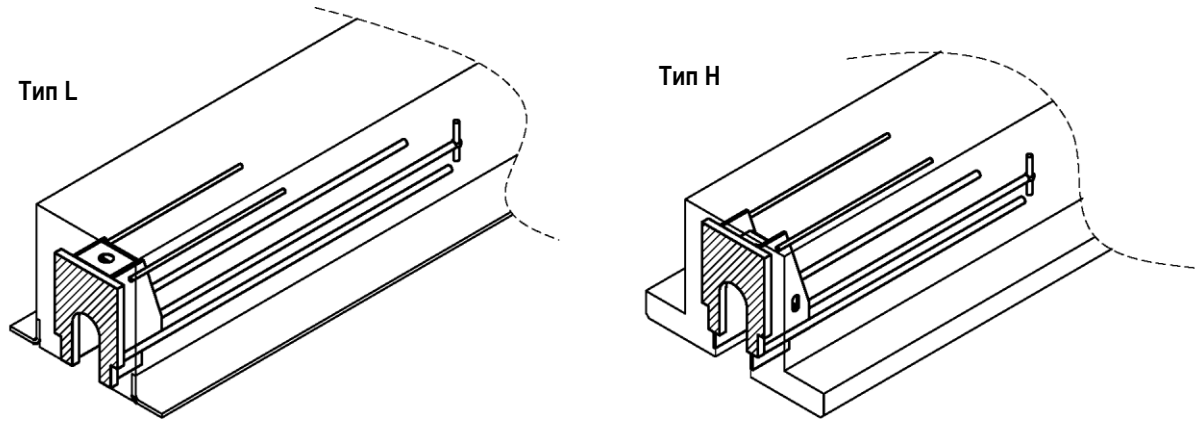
Дополнительная арматура балки, если расстояние между анкерами башмака и основной арматурой превышает 100 мм.
